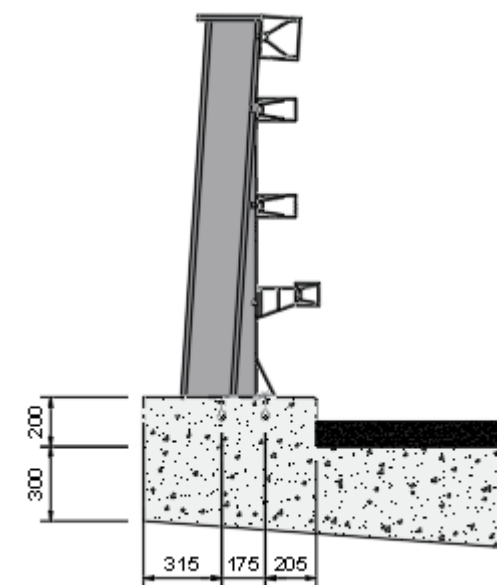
Detalle del recrecido del hormigón para el anclaje del pretil.
